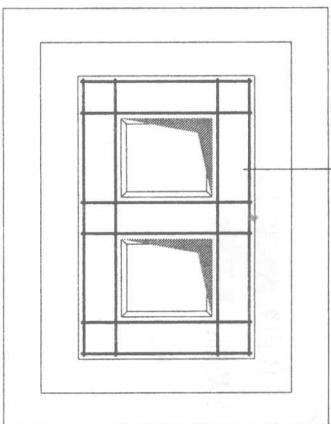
双杯口独立基础顶部焊接钢筋网示意
